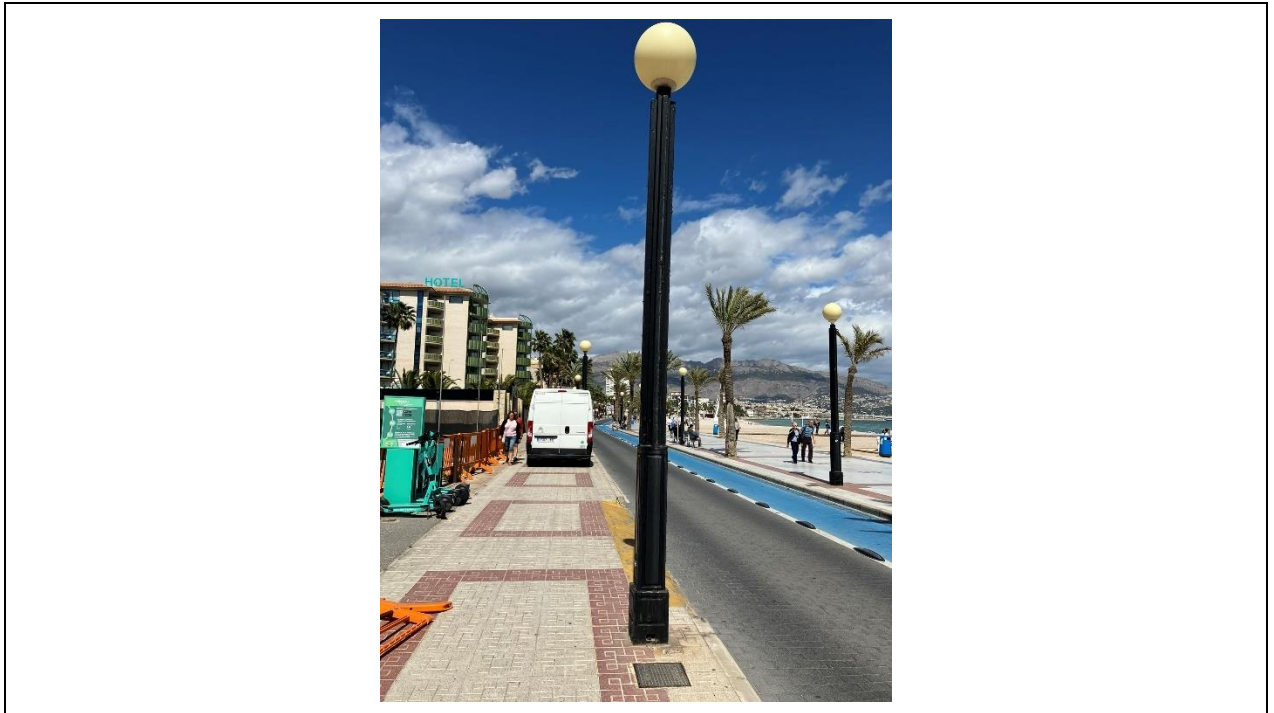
Detalle columna y luminaria tipo existente en el paseo de las Estrellas
